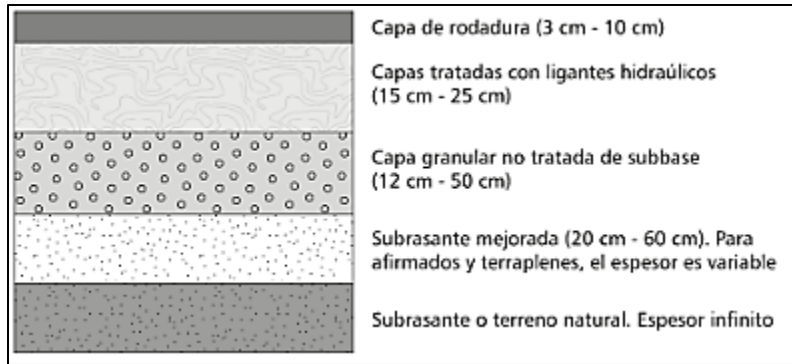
Perfil de estructura de pavimento semirrígido
